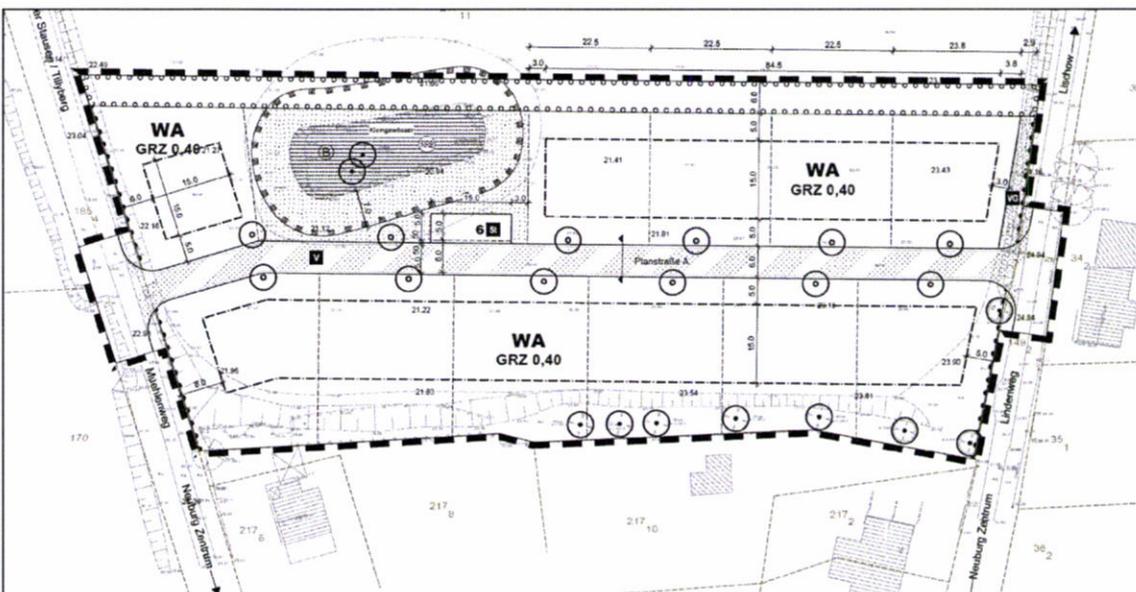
Das Plangebiet im Bebauungsplan (Ausschnitt). Quelle: bab Wismar, 2013.
